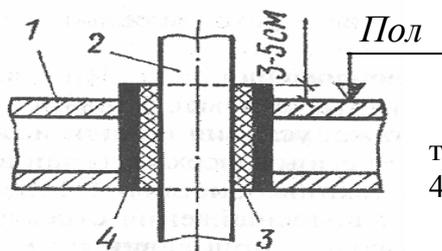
Прокладка трубопроводов через перекрытия: 1 – перекрытие; 2 – труба; 3 – асбестовая заделка; 4 – гильза
